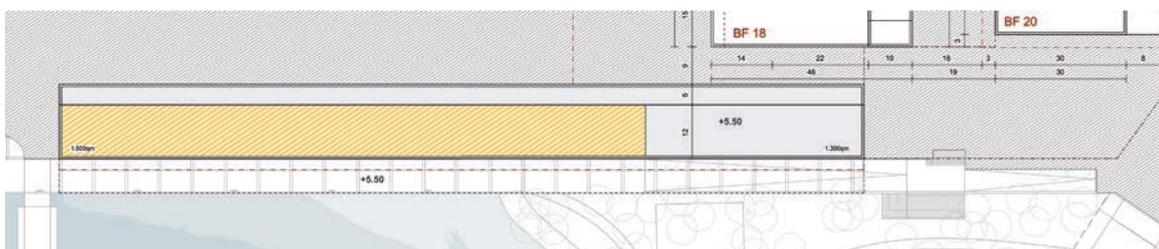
Das obere Warftgeschoss im Grundriss
